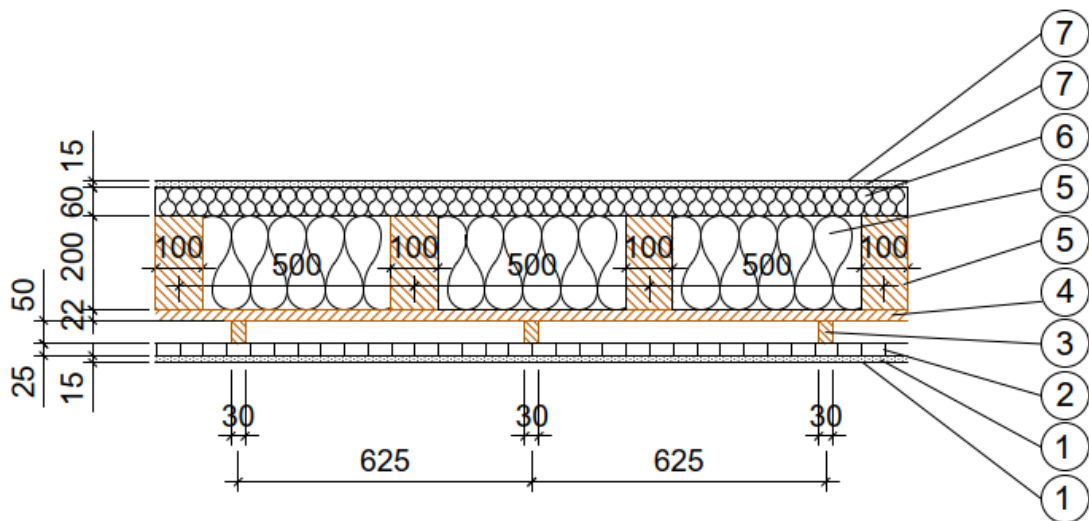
Holz-Ständer-Fassade mit Putzfassade
